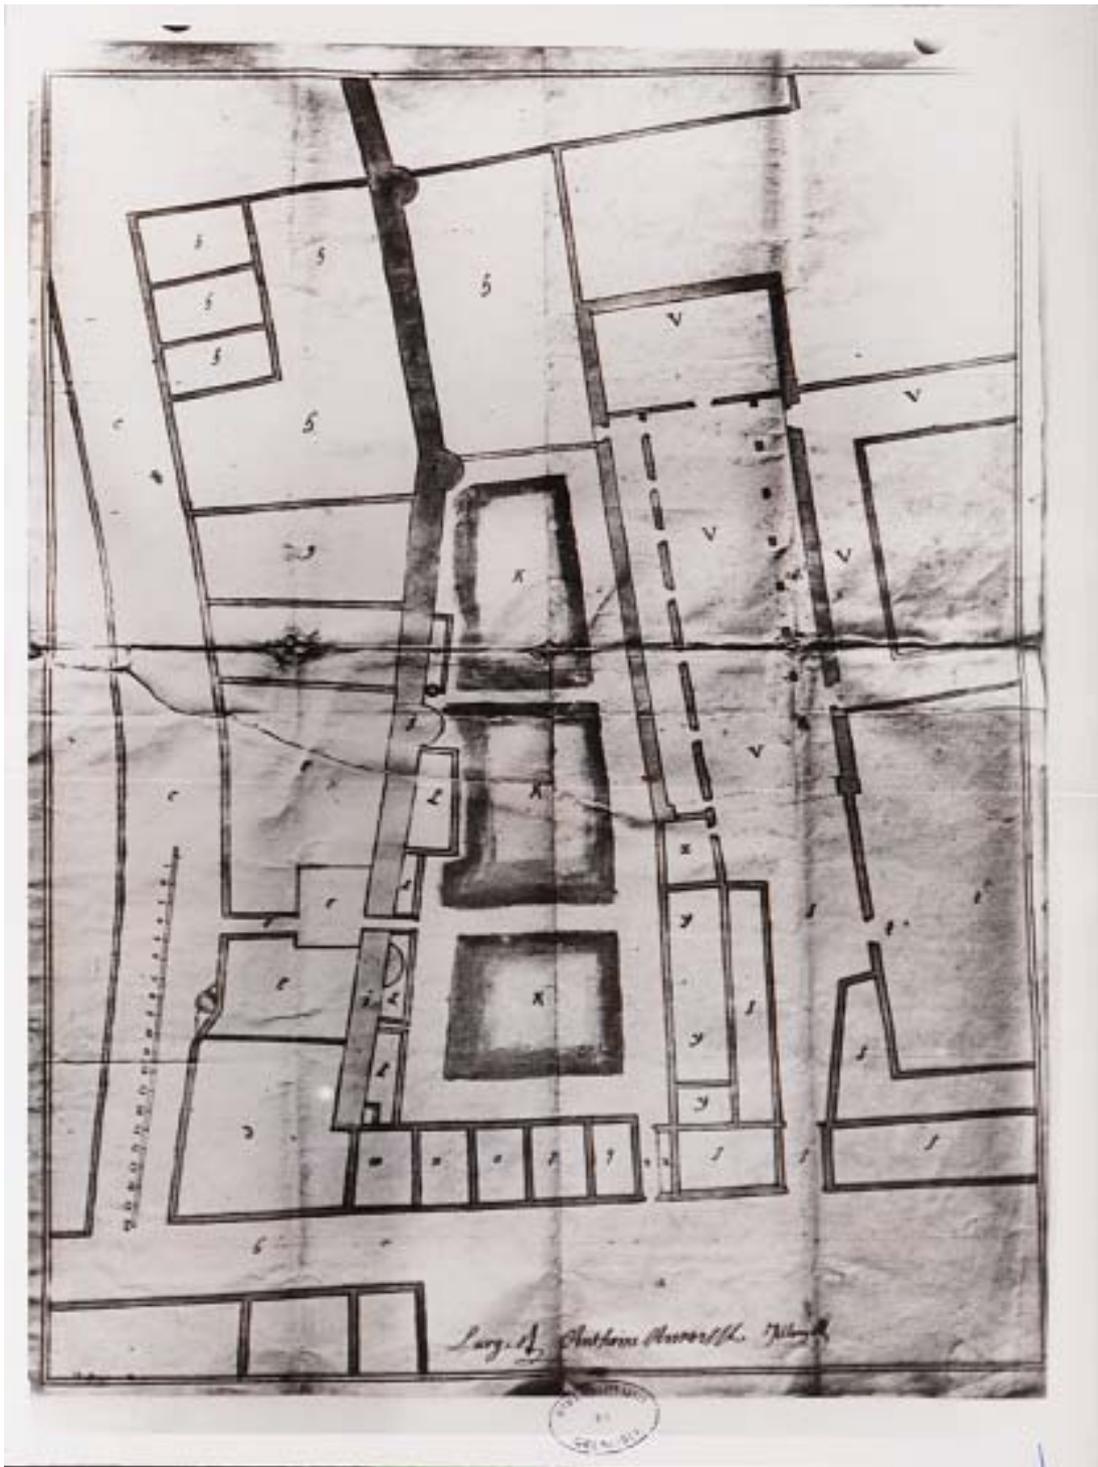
PLAN DE 1662 - ARCHIVES BMG
